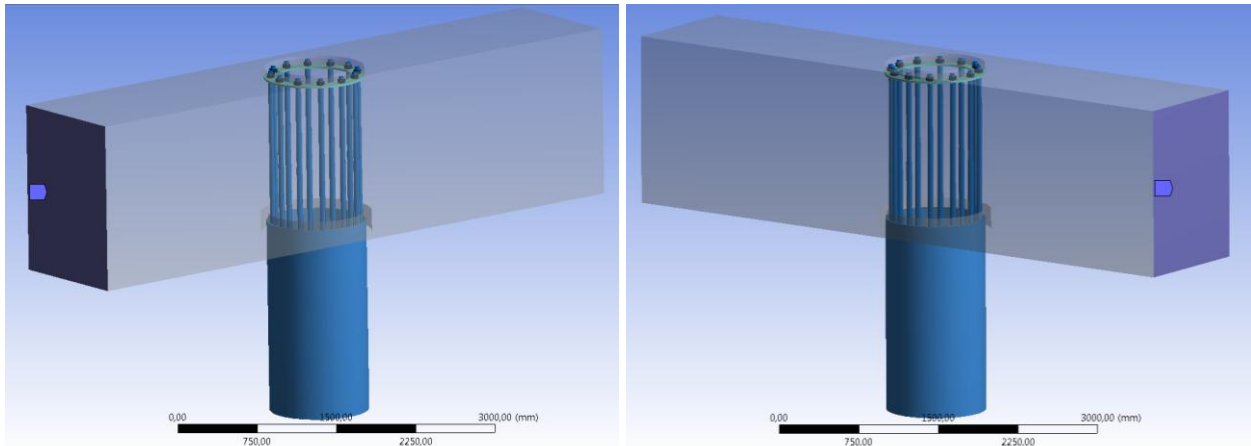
Apoyos fijos en extremos de viga de la conexión con pilote vertical.
